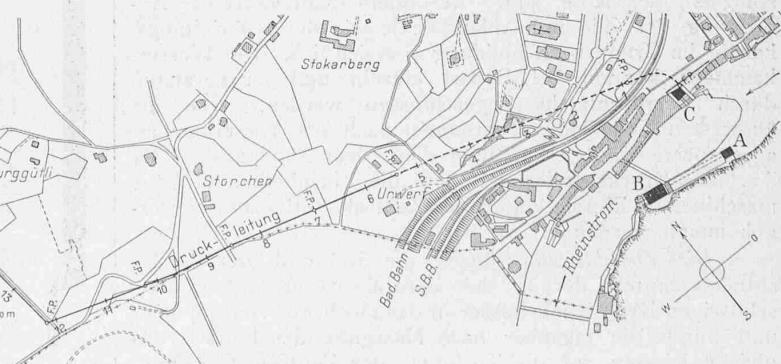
Lageplan der Zentralen A, B und C mit Druckleitung und Hochreservoir zu C. — Massstab 1:12000.
